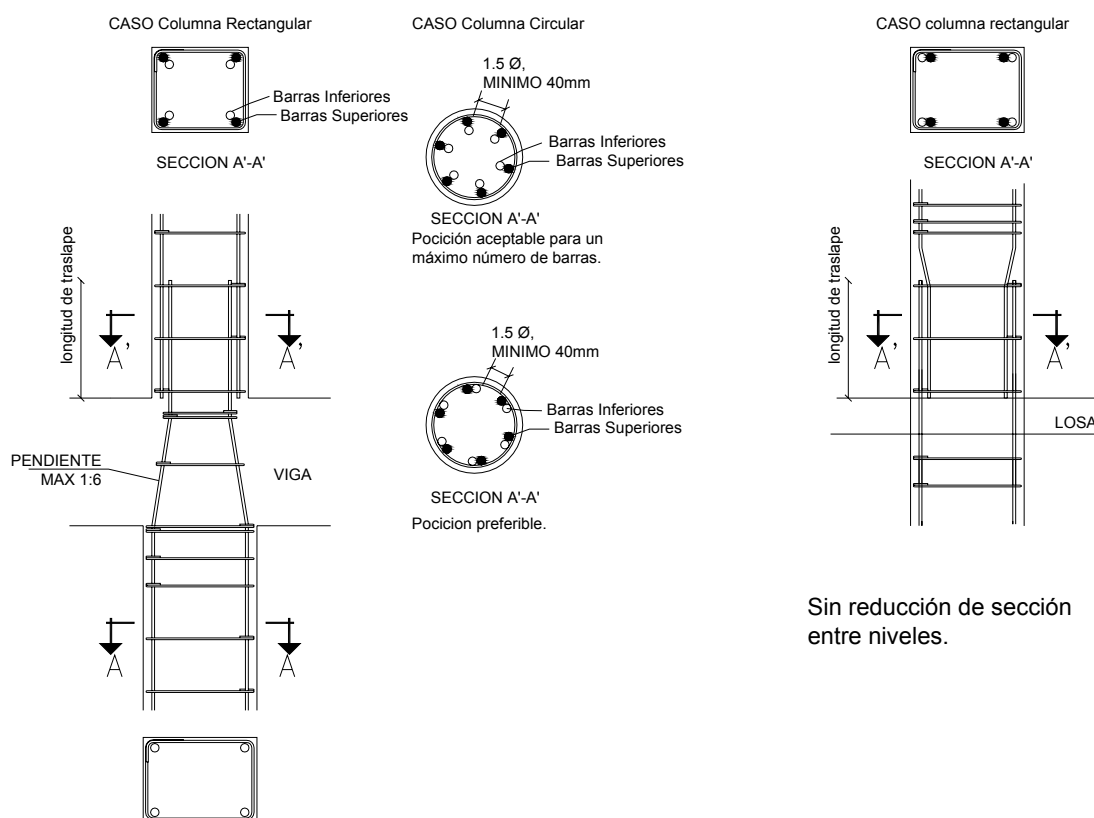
Detalle de empalmes por traslape en columnas
